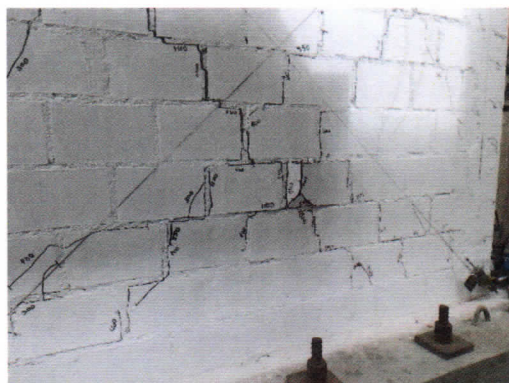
Levantamiento de ladrillo en la parte central de la cara Norte en el 2° ciclo empujando para una distorsión de 1/300.
